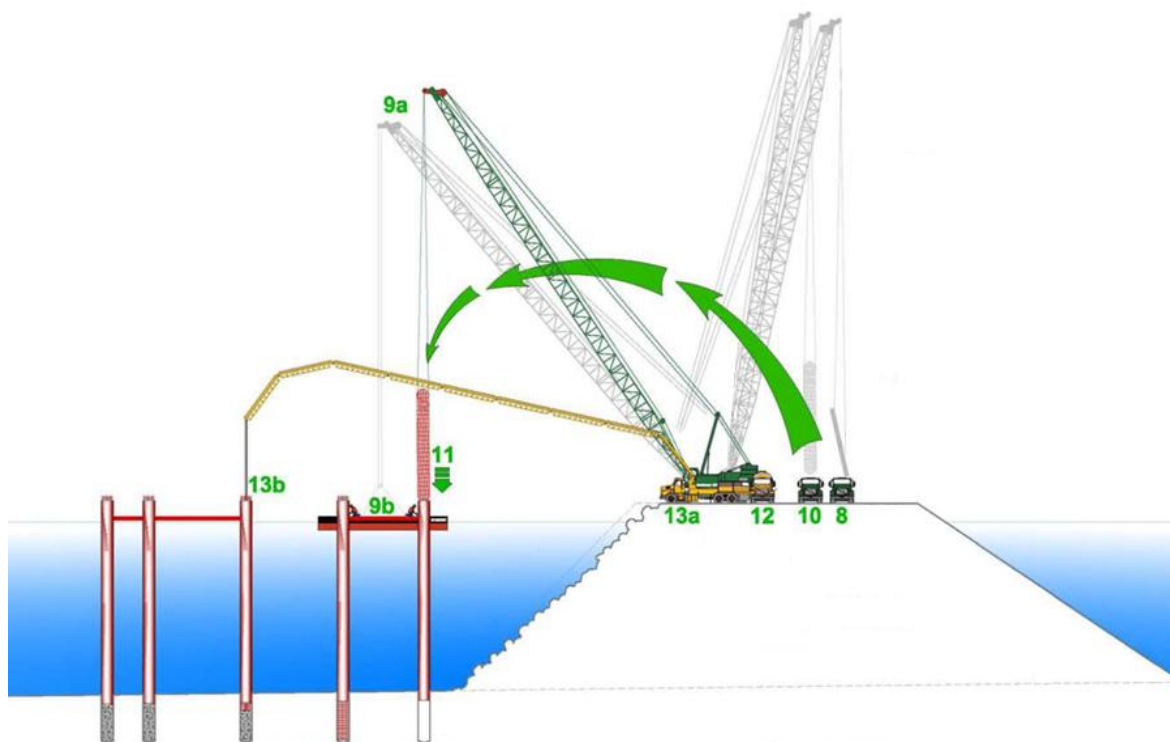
Desenho esquemático – contraventamento e betonagem das estacas
